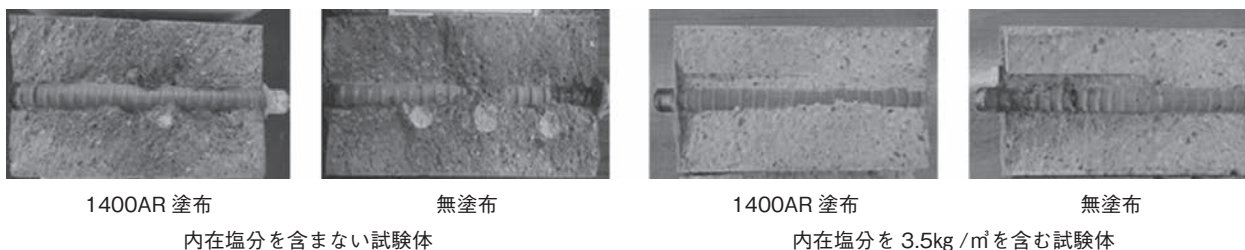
鉄筋腐食促進試験後の鉄筋の発錆状況
